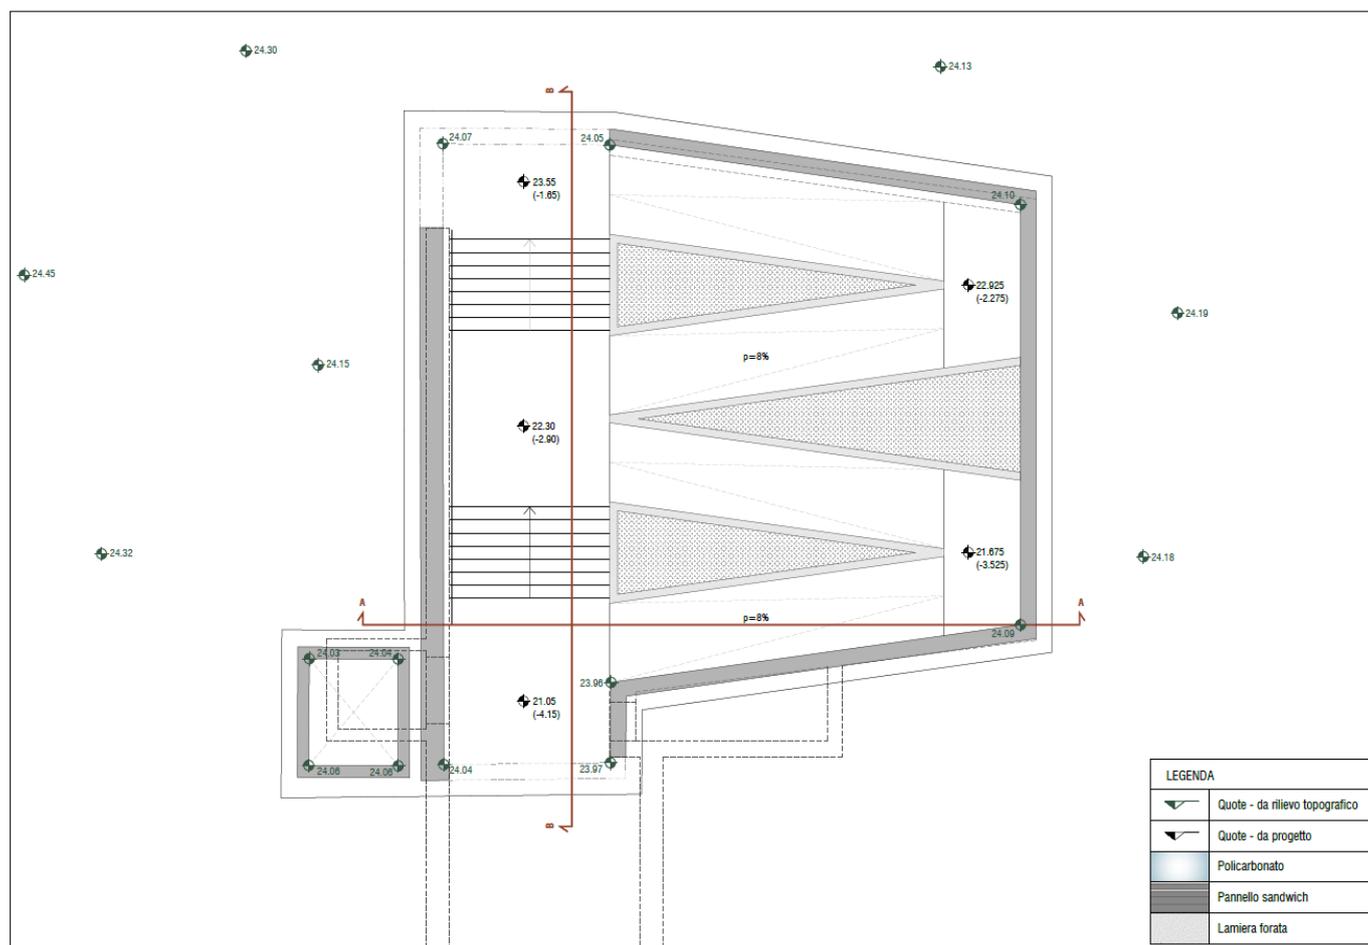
ESTRATTO PLANIMETRIA STATO DI PROGETTO – PIANTA SCALE E RAMPA TETTOIA RFI
